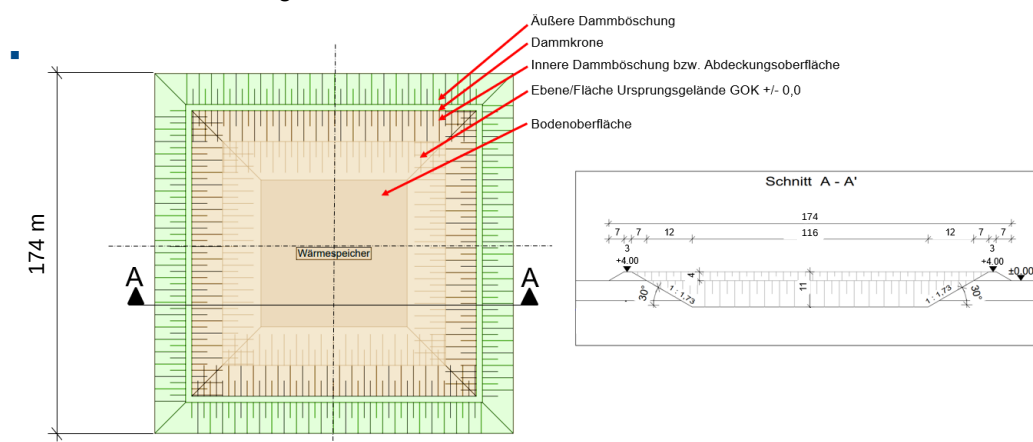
Möglicher Grundriss für den 200 000 m³ Erdbeckenwärmespeicher (links) und Vertikalschnitt mit Bemaßung (rechts)
